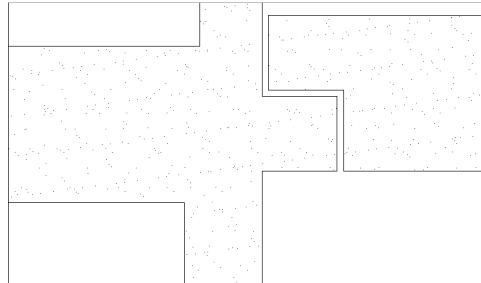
Pormenor da consola curta inserida em parede de betão armado (s/escala)
